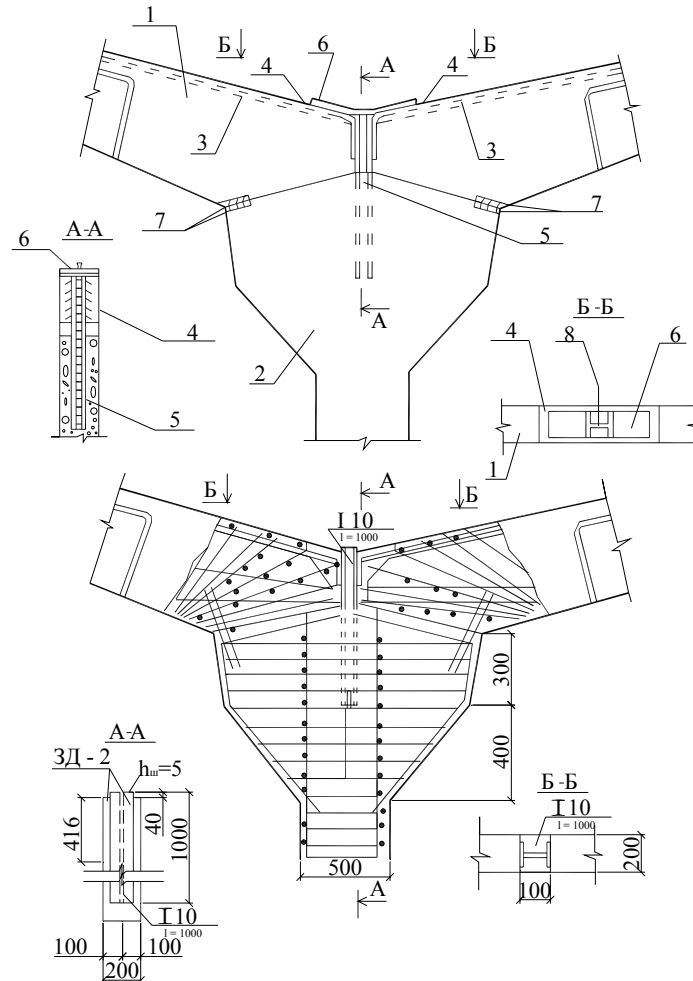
Варіант №3 конструкції вузла з'єднання ригелів з середньою стійкою (ЦНИИЭПсельстрой): а- опалубні розміри; б- армування; 1 – ригель; 2-середня стійка; 3- розтягнута робоча арматура; 4- гнута закладна деталь; 5- двутавр
